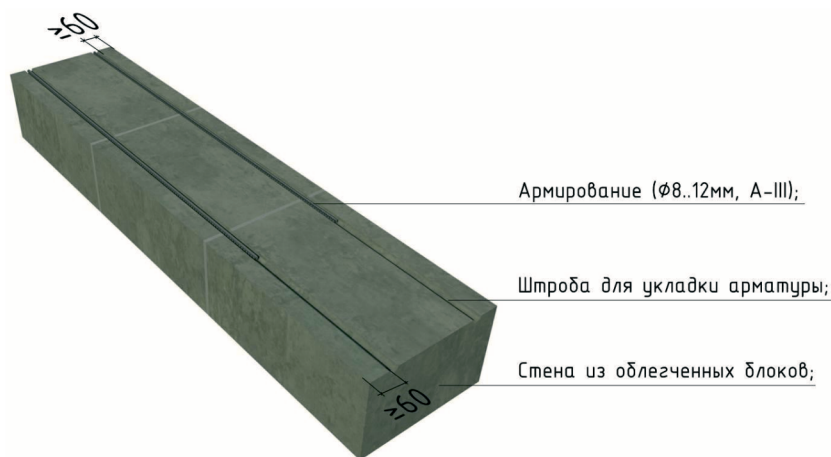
Схема армирования кладочного пояса на уровне расположения межэтажного перекрытия.
